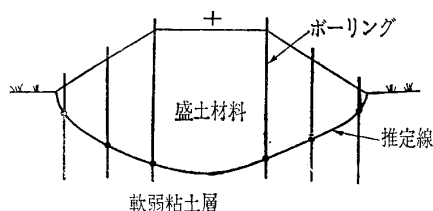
b 在来線の簡易調査ボーリングによる断面図
